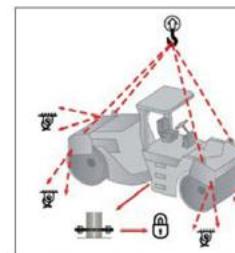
Equipo de trabajo provisto de puntos de amarre para levantamiento y amarre.
